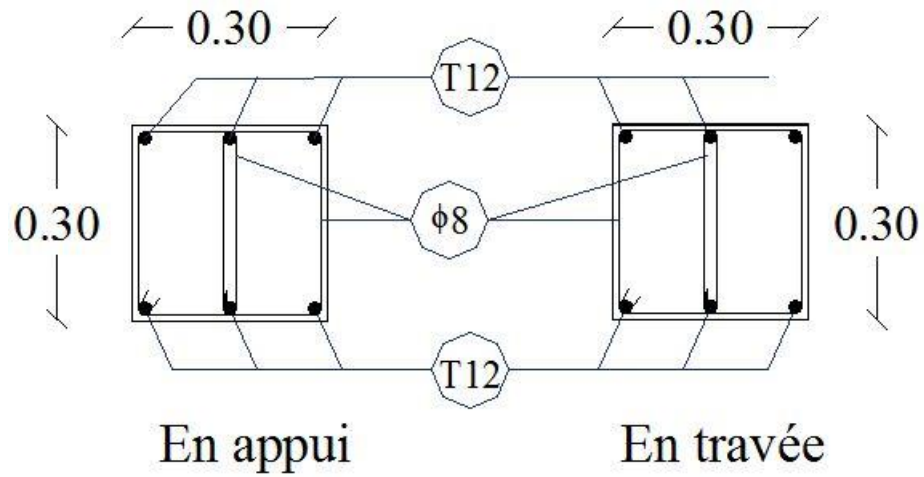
Ferrailage des poutres secondaires (bloc 1/2/3)
